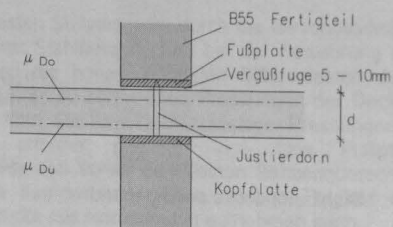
Stahlbetondecke zwischen Fertigteilstützen
